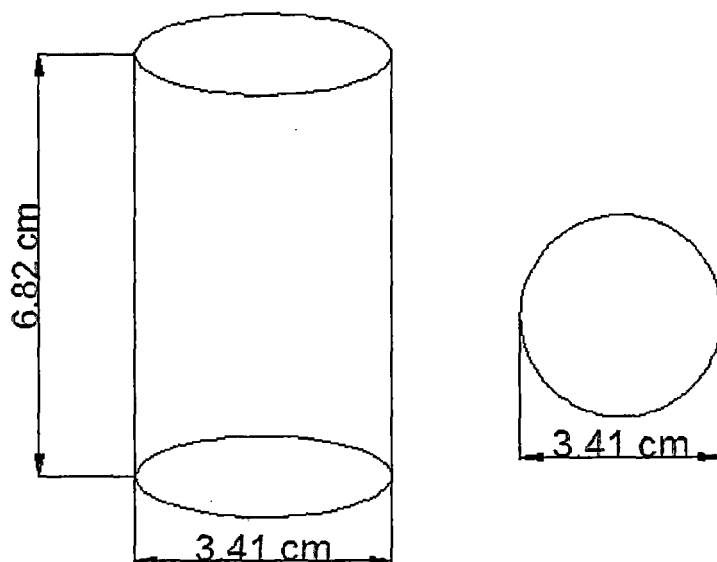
Dimensiones de probeta para ensayo de compresión axial no confinada.
